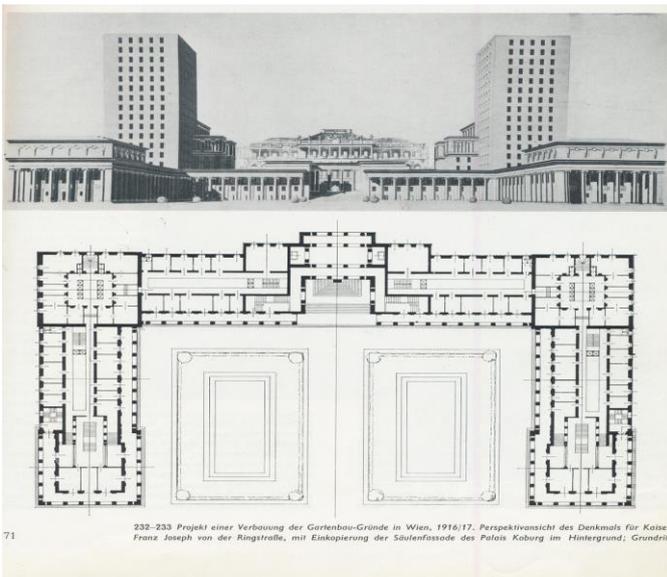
Adolf Loos, Projekt zur Verbauung der Gartenbaugründe, 1916/17, Fotomontage mit Perspektivansicht und Fassade des Palais Coburg (oben), Grundriß (unten)
